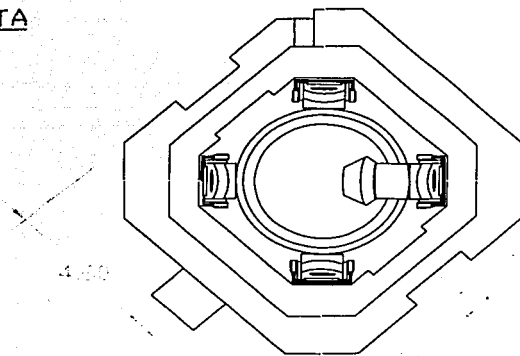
A. ARREGLO FINAL DE LA PLANTA
